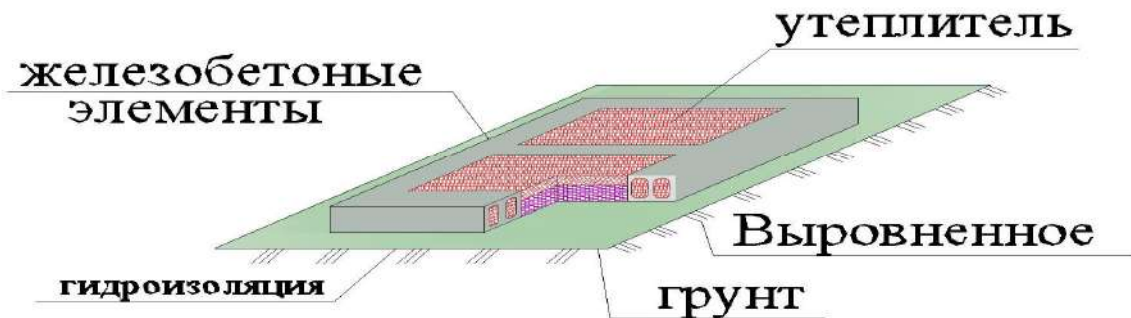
Ленточный плитно-рамный фундамент. Общий вид
